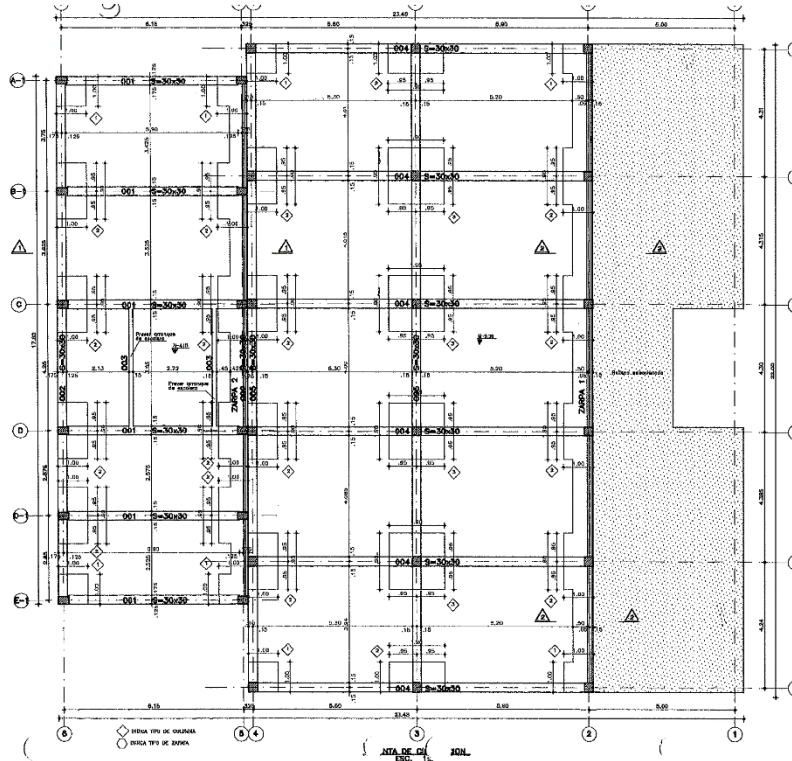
Vista en planta de cimentación existente. Fuente: Planos de estructura existente. Alcaldía municipal de Tibirita.
